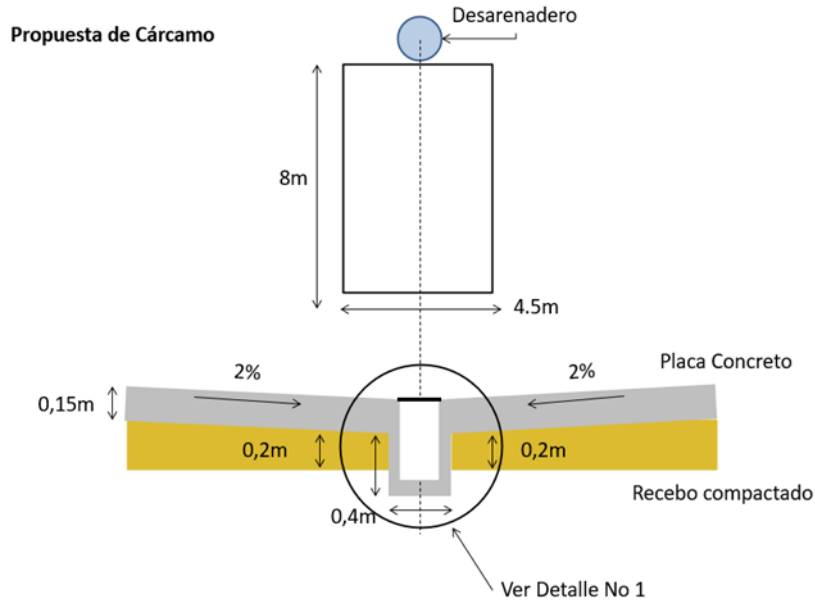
Detalle propuesto de placa y cárcamo lava llantas
